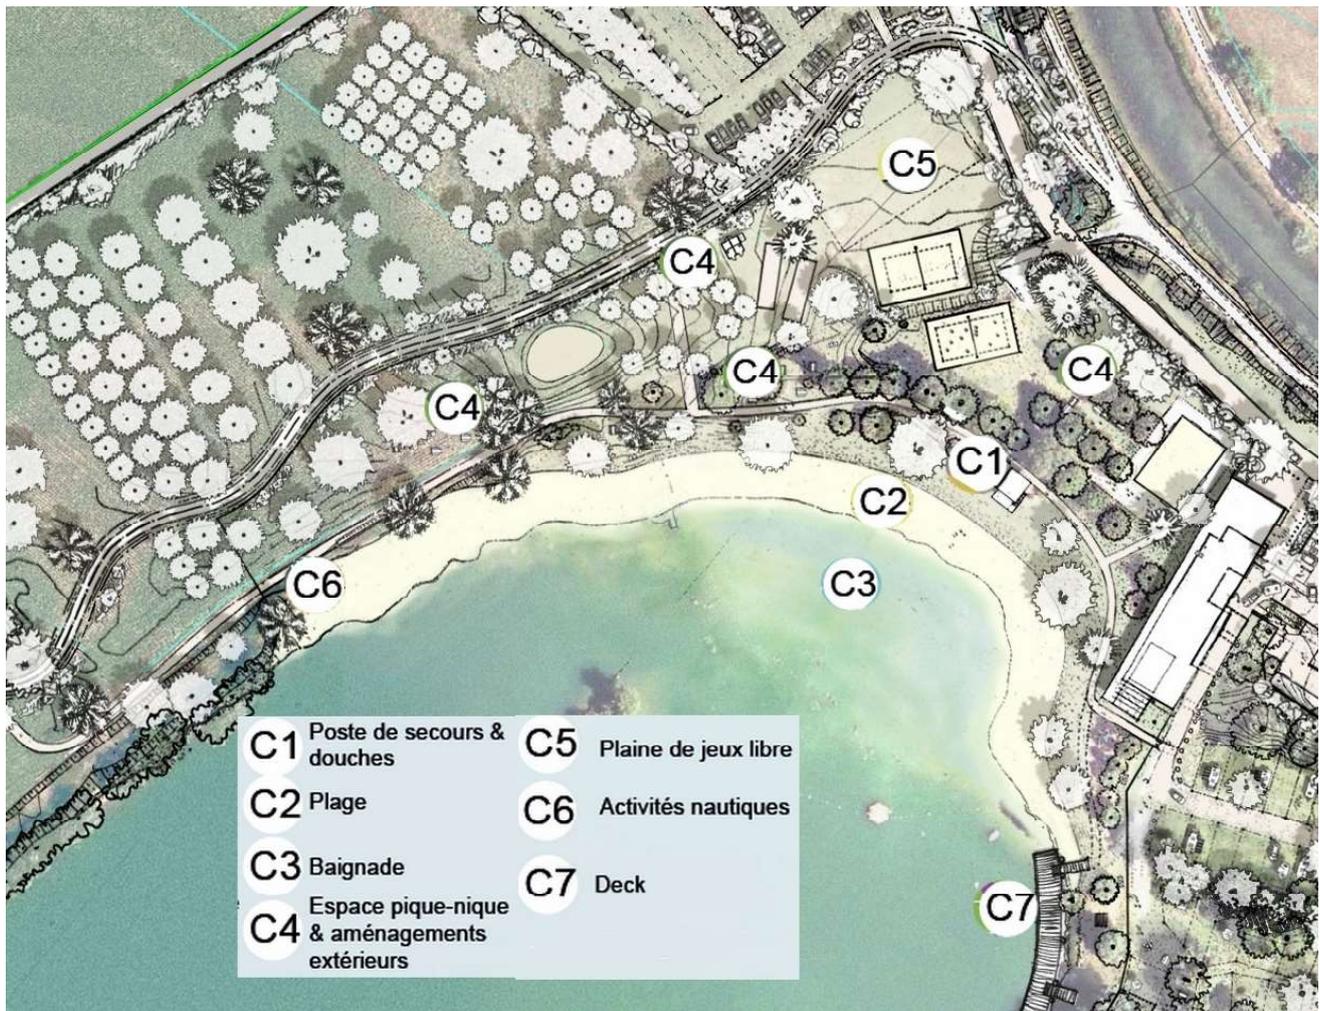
Plan de masse du projet – Zoom sur l'espace loisirs (GBM, 05/2022)
